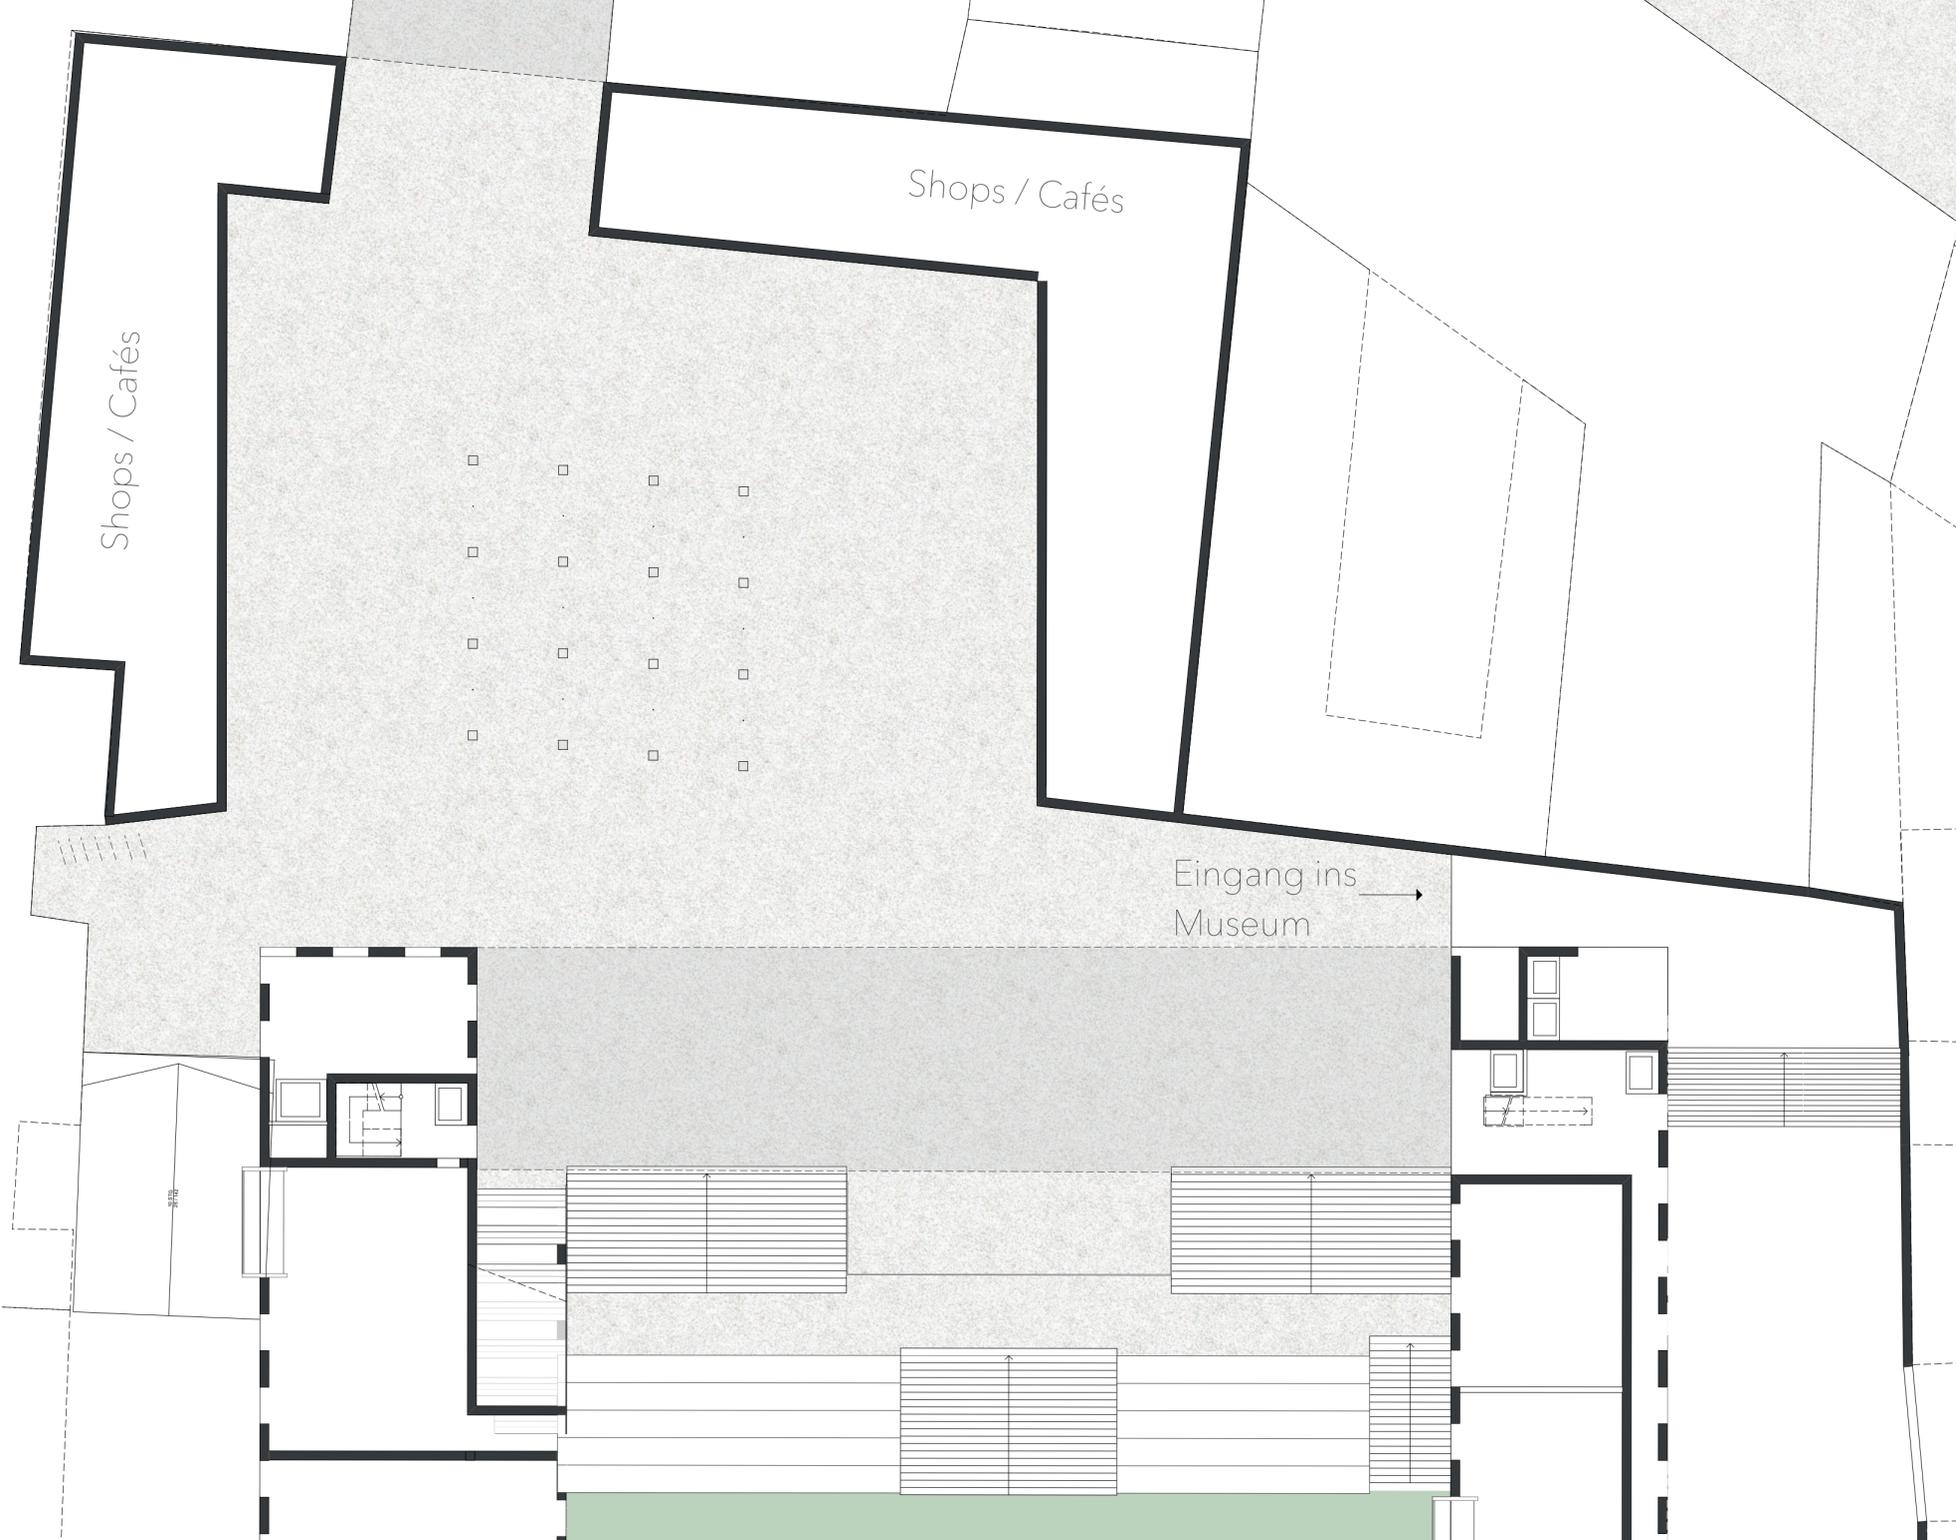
Erdgeschoßniveau 1 - 250 auf Level des 1. OG mit dem Haupteingang in das Museum
